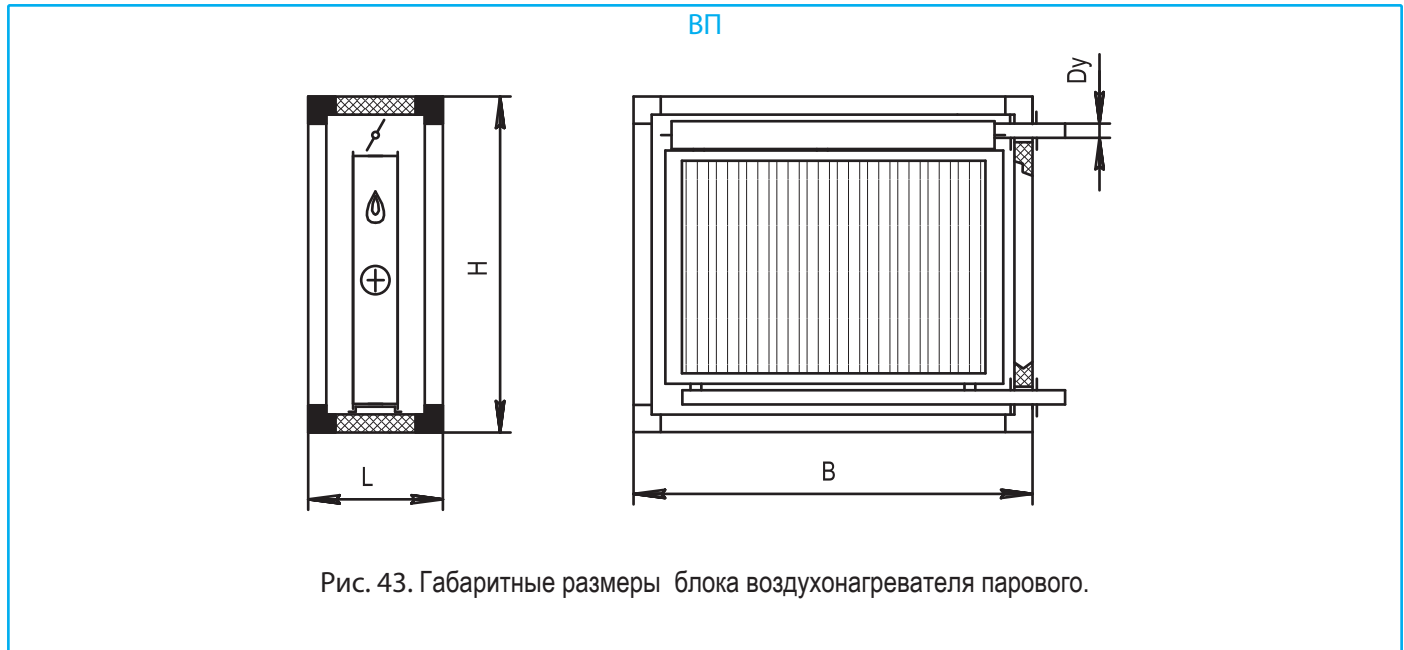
Габаритные размеры блока воздушонагревателя парового.
